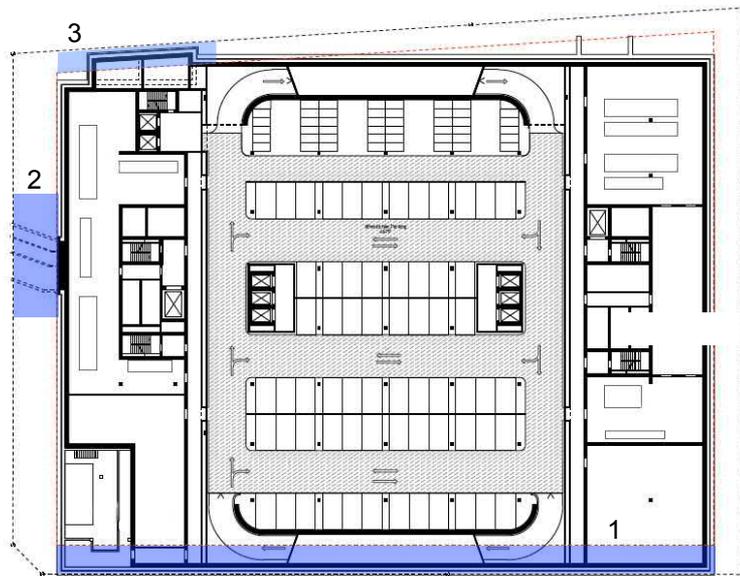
2. Untergeschoss gemäss Richtprojekt Stand 04.07.2017
